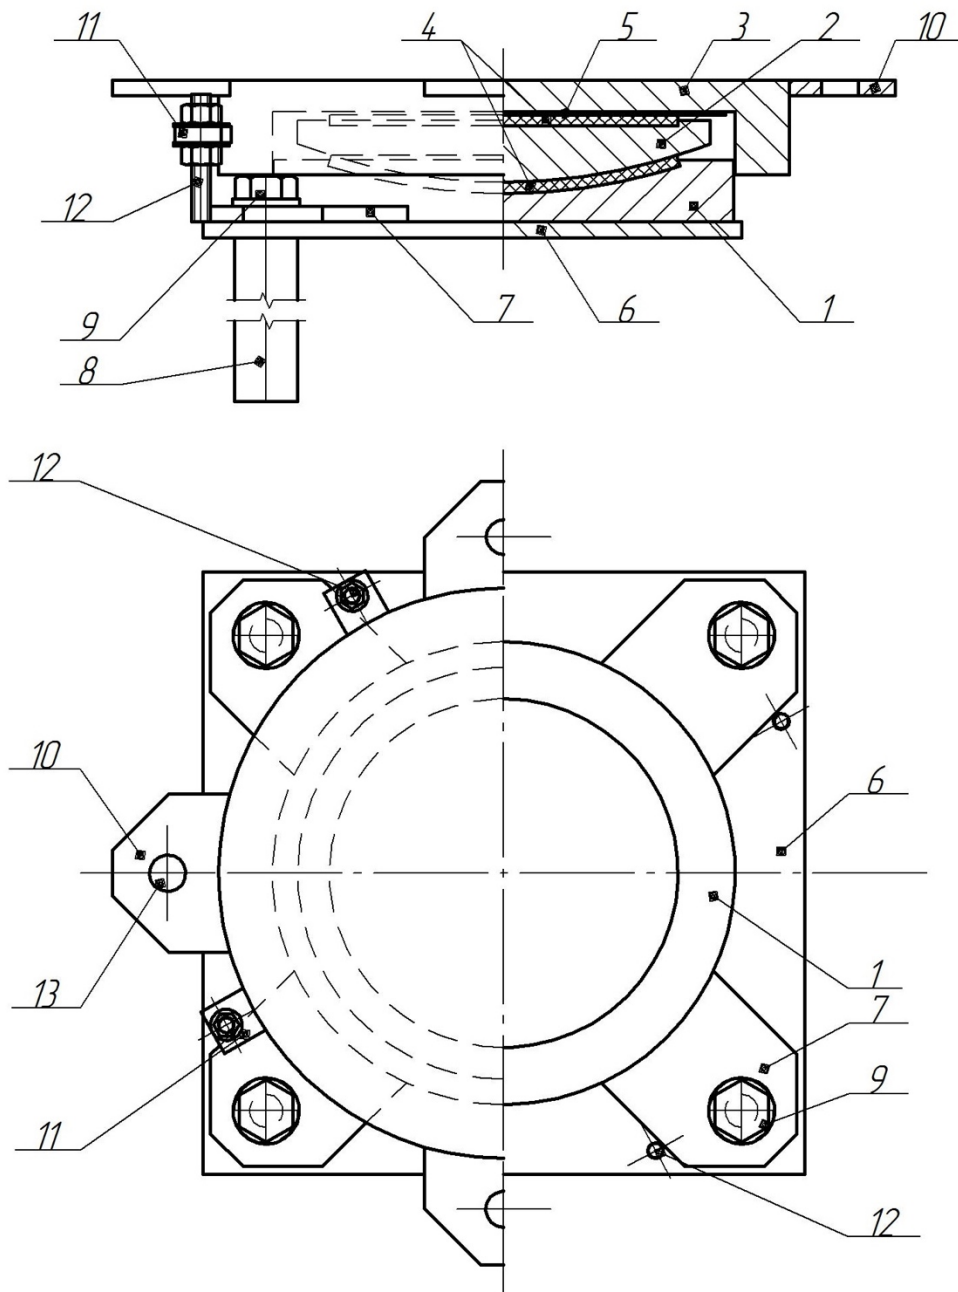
Конструкция всесторонне-подвижной опорной части Н СФОЧ.
